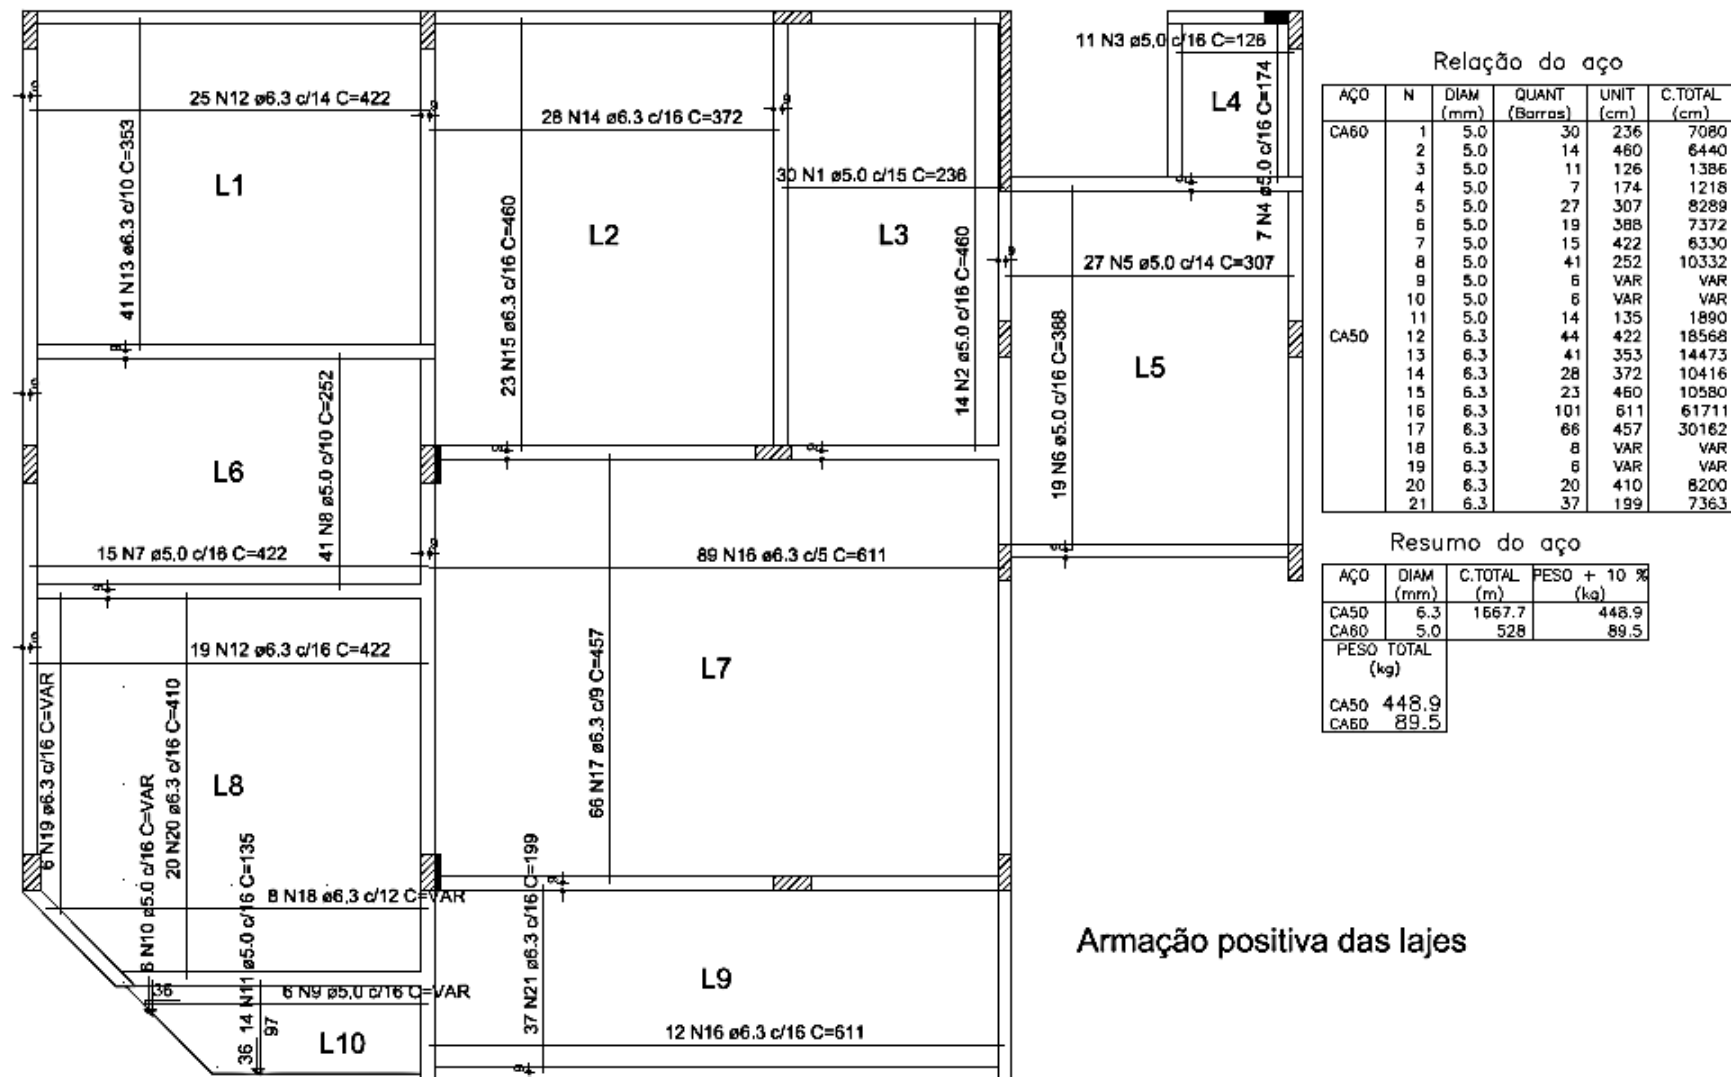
Detalhamento da armadura positiva das lajes modelo 8
